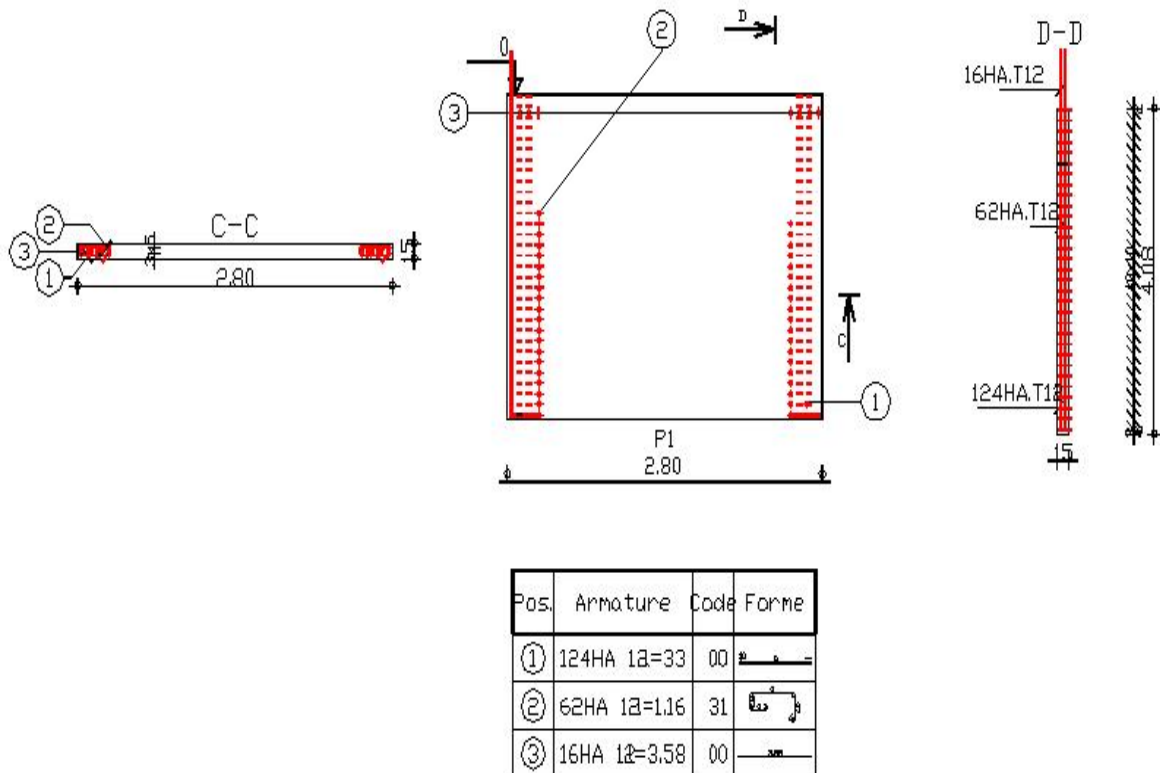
ferrailage de voile 15 cm coupe C-C et D-D
